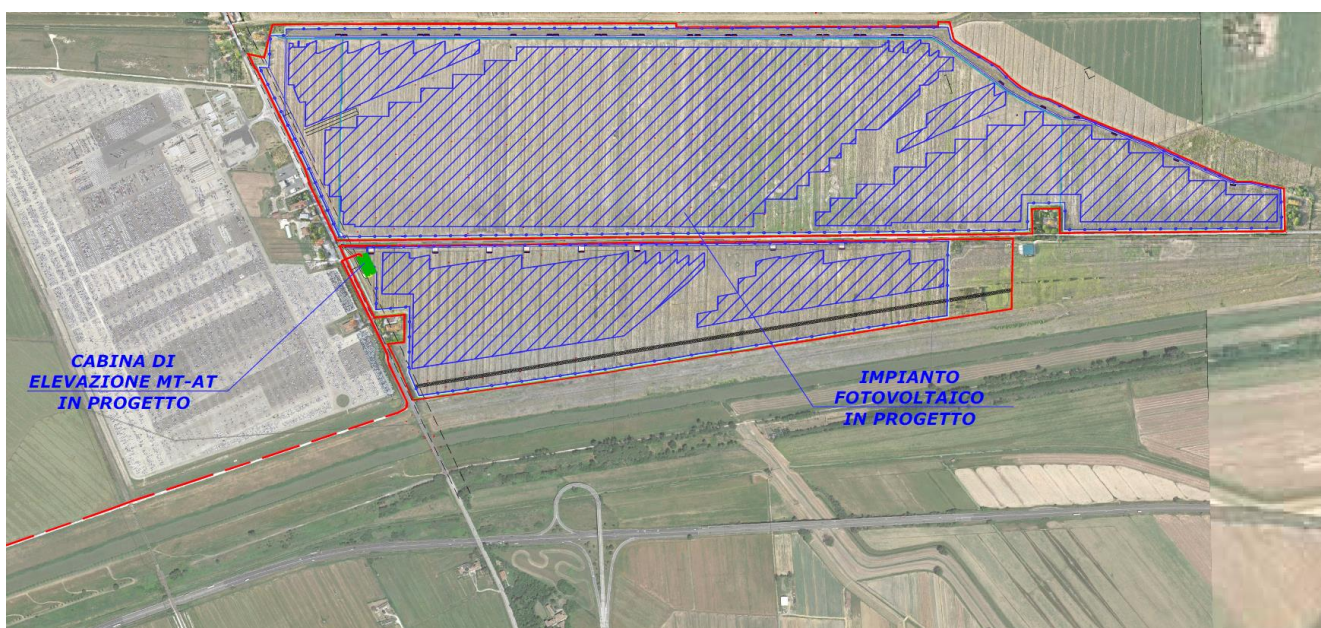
planimetria di progetto con indicazione dei pannelli e delle principali opere interessate dell'impianto
